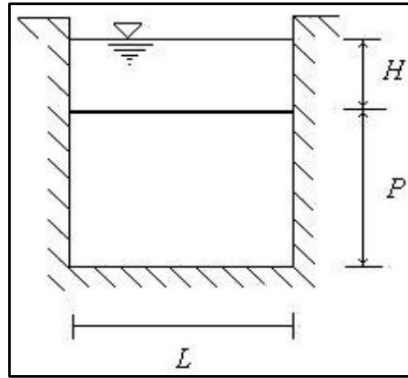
Vertedero rectangular de cresta delgada sin contracción.
